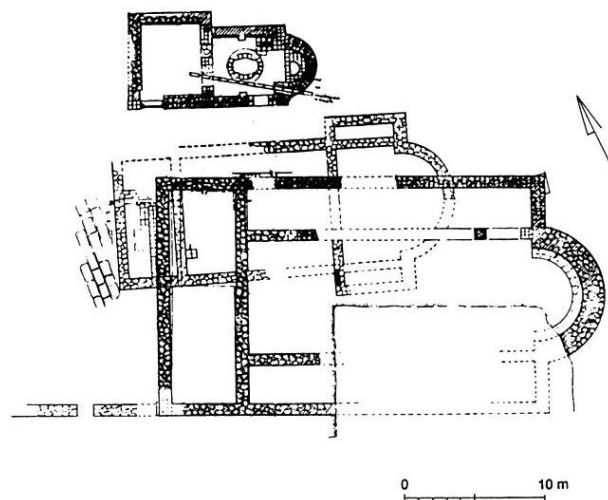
Serdica*, Kirchen *extra muros*, Grundriss (nach M. STANČEVA, Раннохристиянски култови сгради, 160 Abb. 1)
